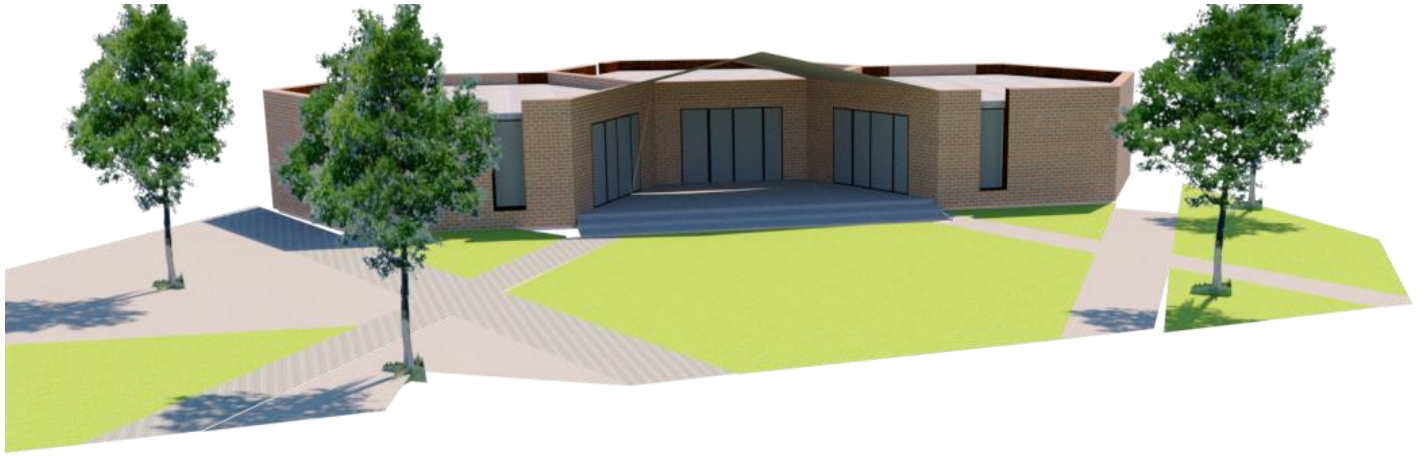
render de talleres fachada norte Fuente: Elaboración propia
